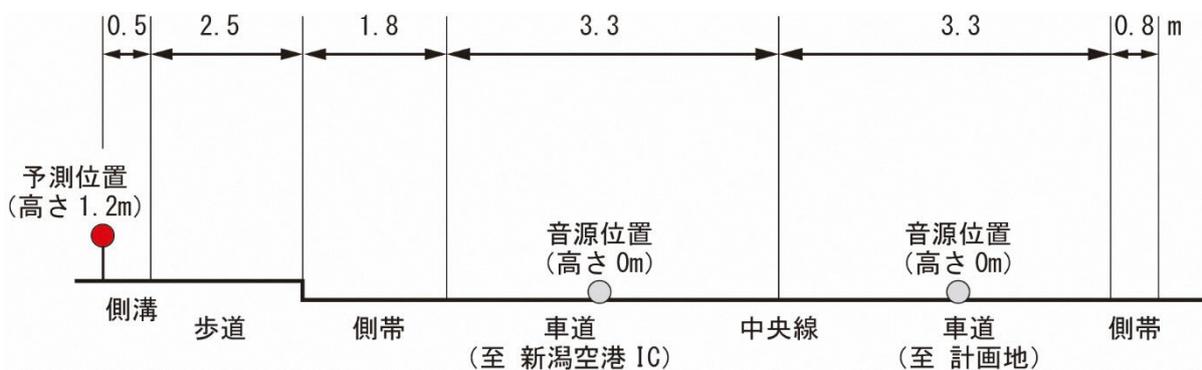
(3) 道路断面図 (No.3: 嘉瀬蔵岡線沿道 (東側))
